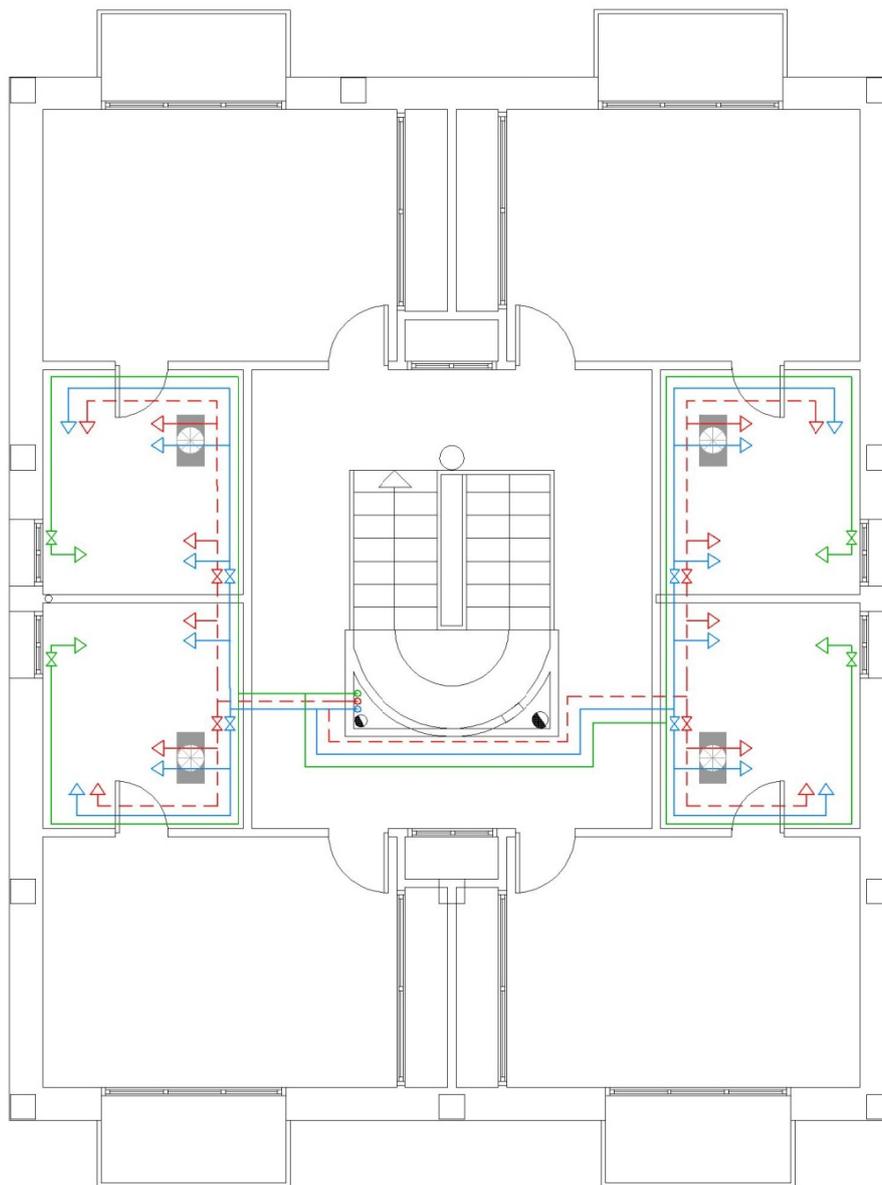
Plano instalación sistema Aquareturn en Planta Primera
